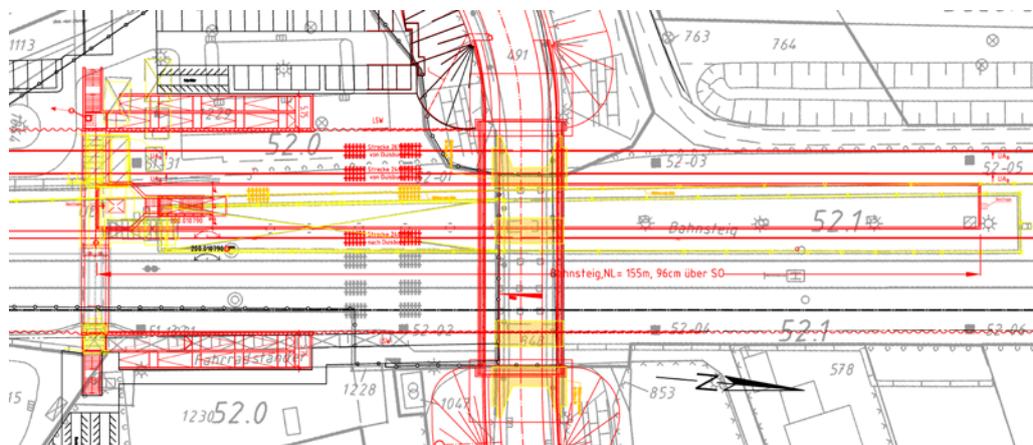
Variante „höhengleiche Erweiterung“, Haltepunkt Angermund, Lageplan [25]
